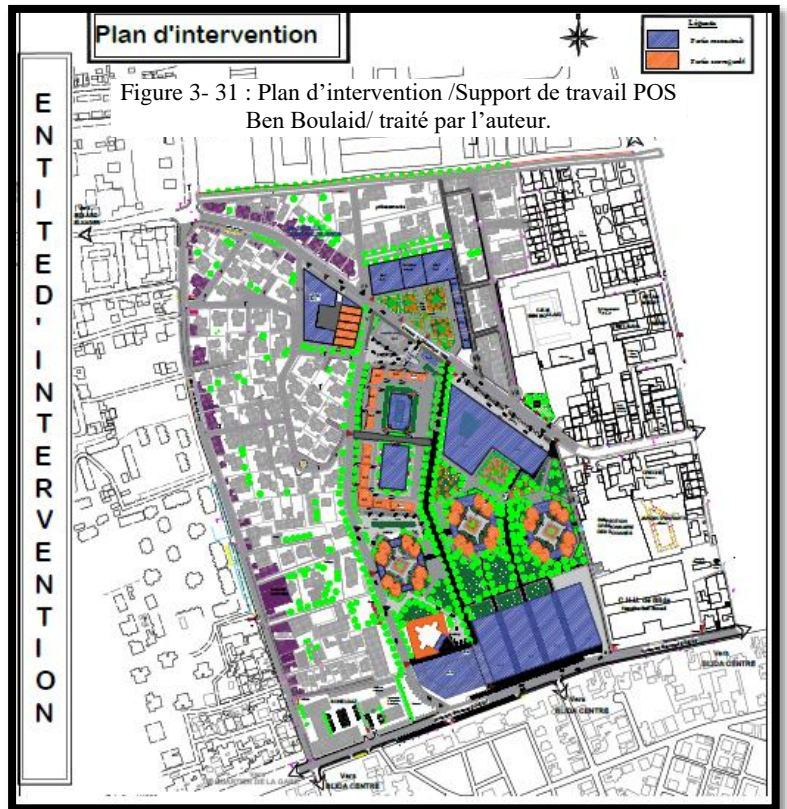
31 : Plan d'intervention /Support de travail POS Ben Boulaid/ traité par l'auteur.
